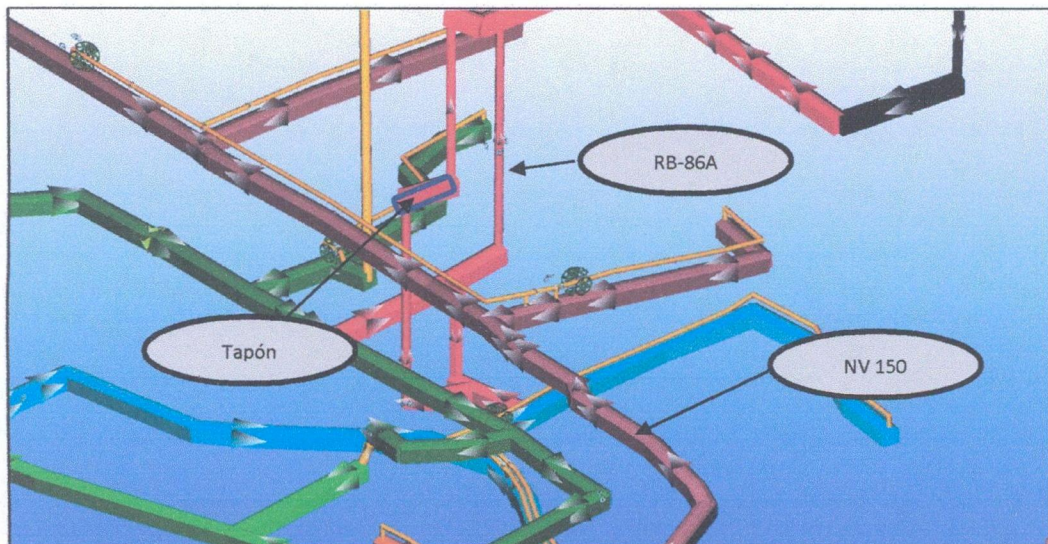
Vista, plan de trabajo proyectos veta principal.
